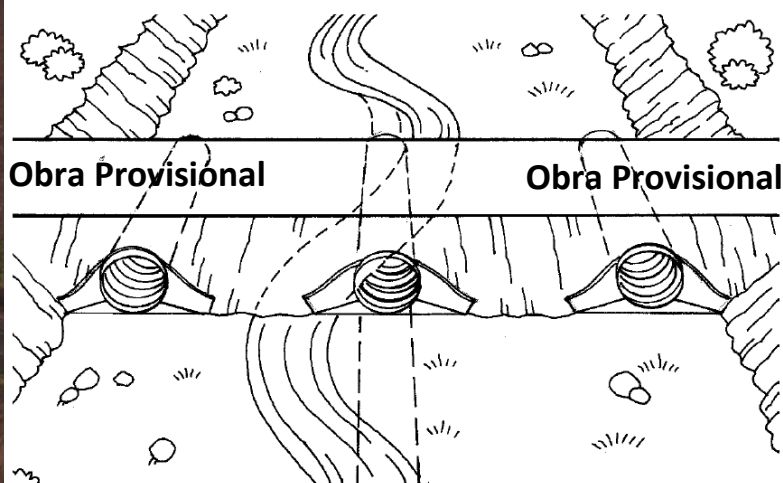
Vista representativa de la Instalación de alcantarillas dentro de un cauce amplio; tomado de Gordon Keller y James Sherar, 2004.
